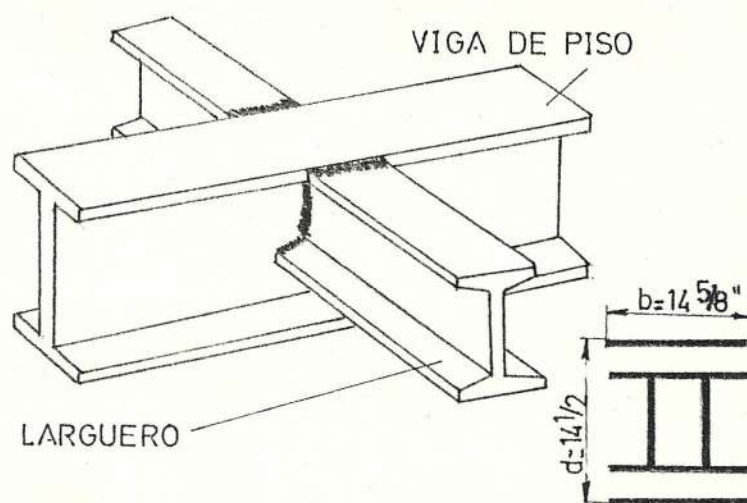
UNION SOLDADA VIGA - LARGUERO.
